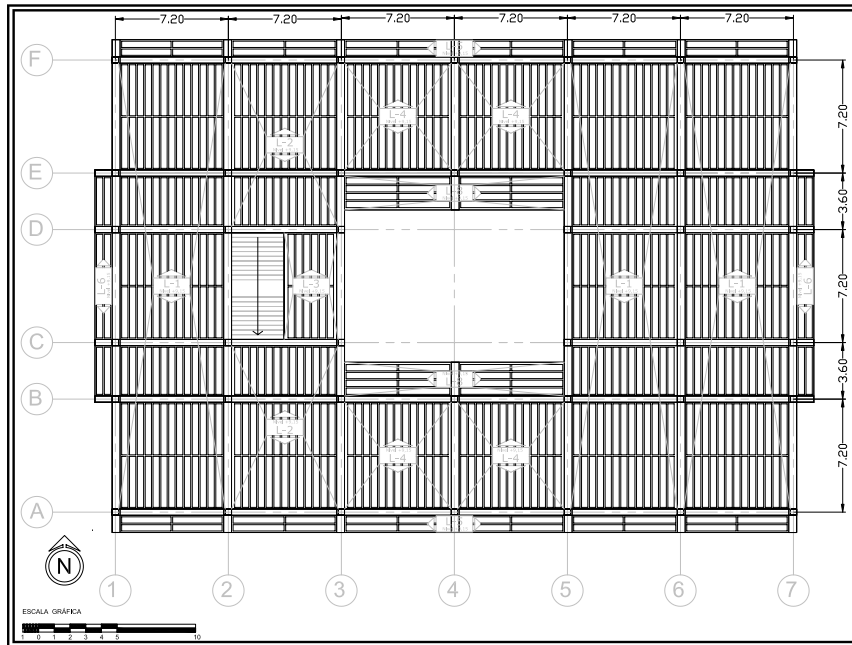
Plano de envigado en planta, nivel 3, mostrando la dirección de armado de losas
